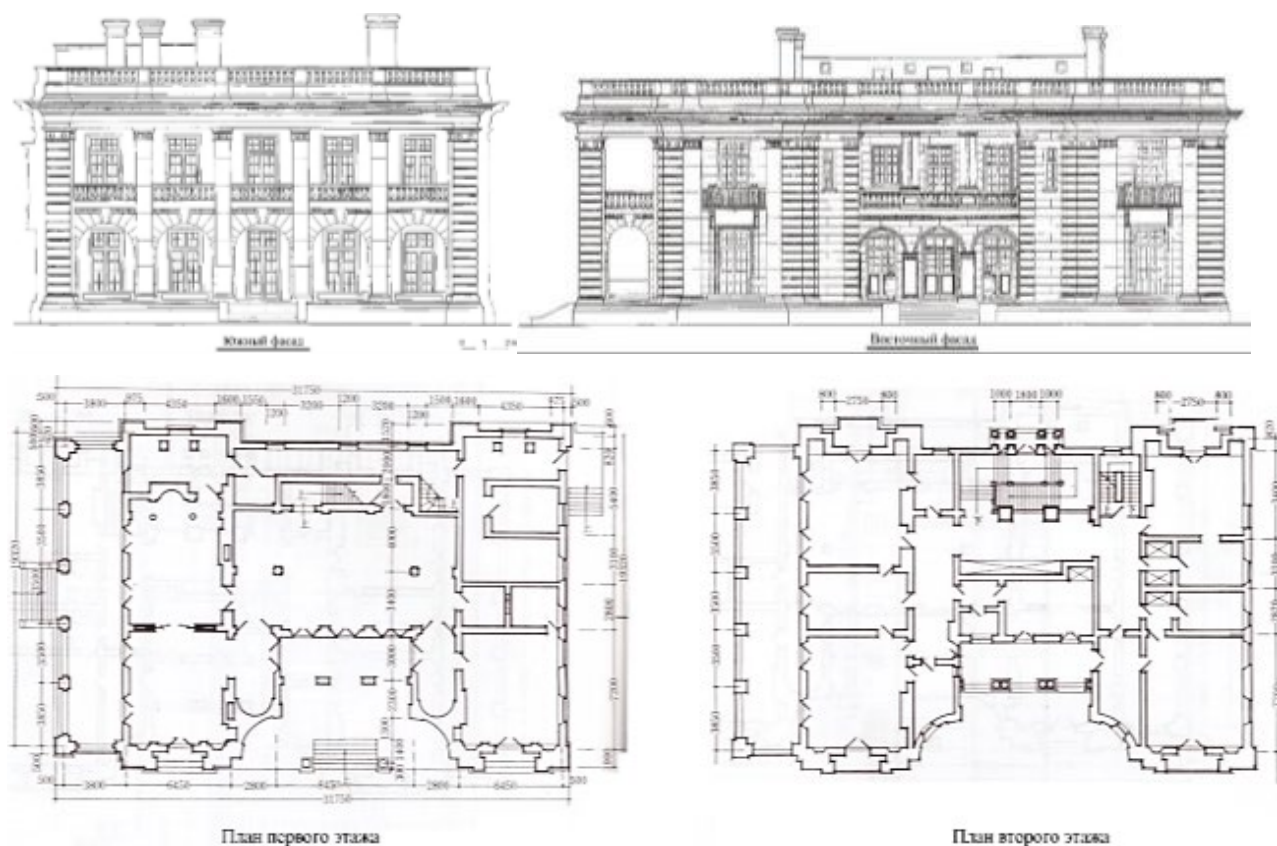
Фасад и план жилого дома в концессии Шамиан «Британская квартира», 1910-е гг. [5].
